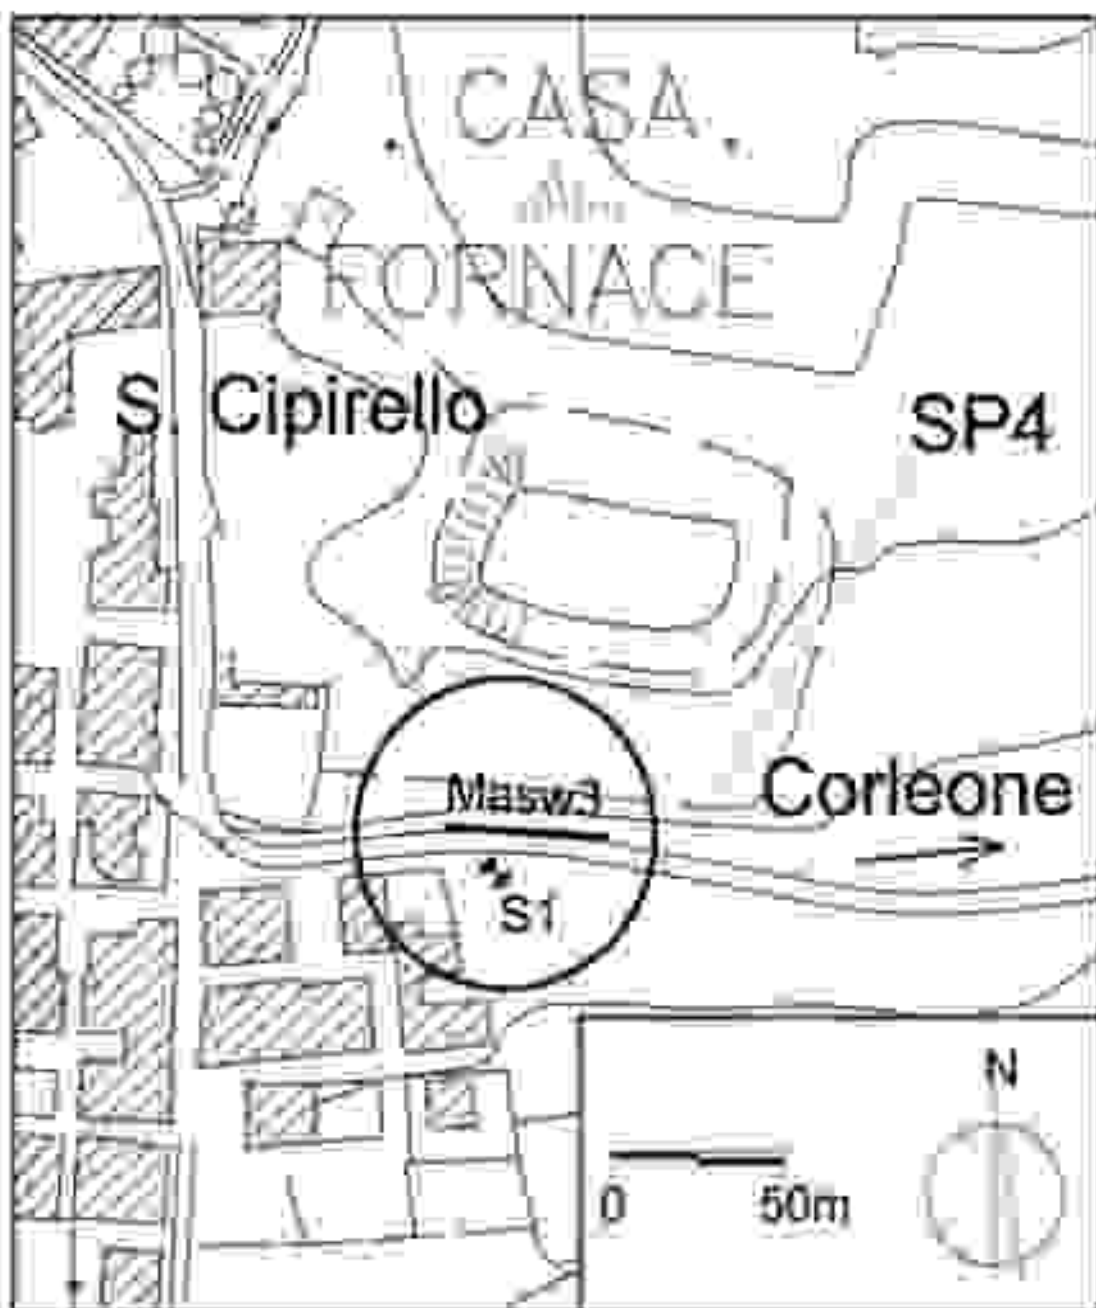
Planimetria con indicazione della zona oggetto di interesse al km 0+500e delle indagini eseguite. Il sondaggio S1 è stato attrezzato con piezometro a tubo aperto.
